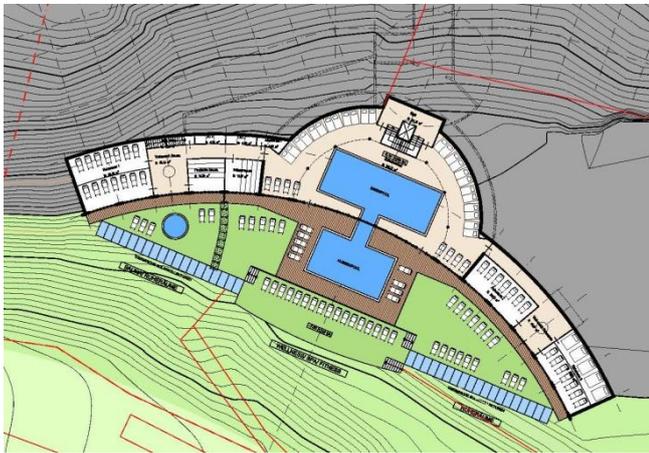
Grundriss Schwimmbad „Hotel Mösern“ in geschwungener Form mit klarer Südorientierung sämtlicher Räume
